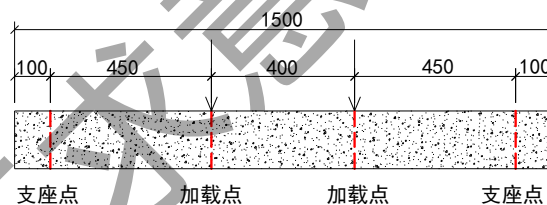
粗骨料活性粉末混凝土板加载示意图（单位:mm）
